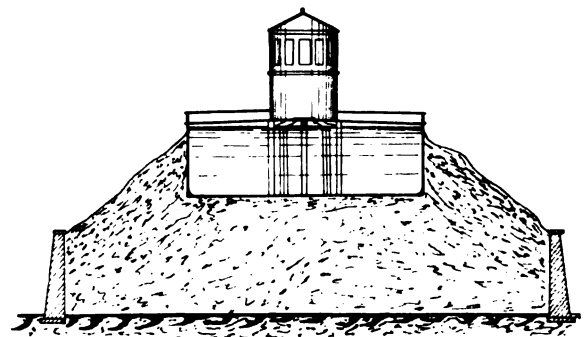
Schnitt durch den Behälter der Stadt Mauguio.
